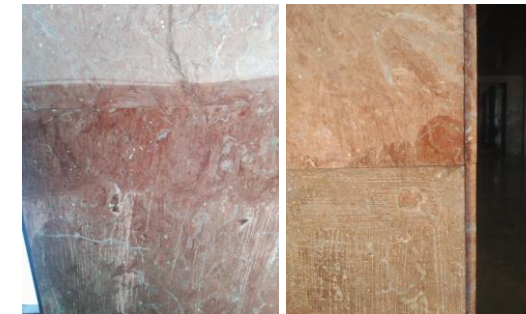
Mármol en zona de portería donde se muestra el cambio tras el lijado y abrillantado
